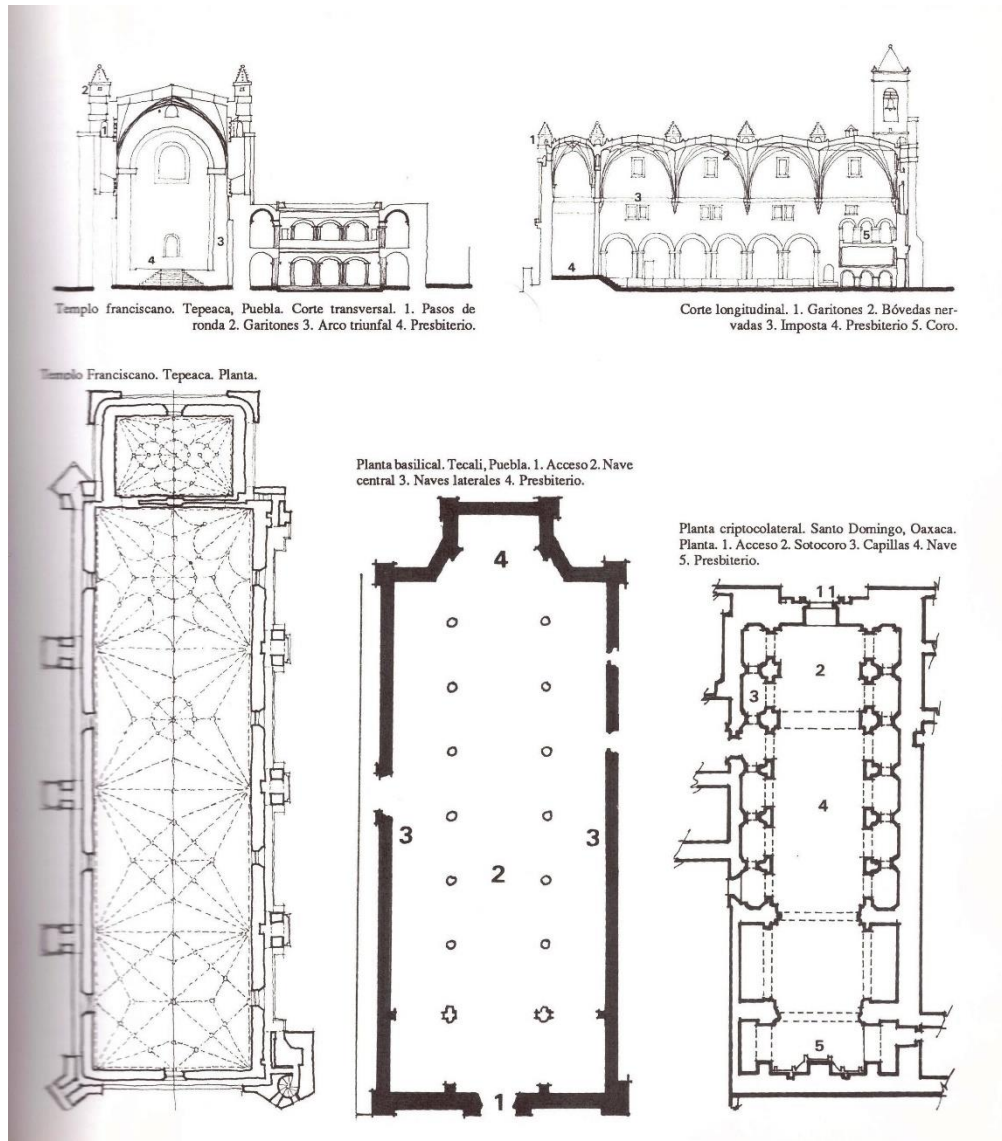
En sentido de las manecillas del reloj: corte transversal, longitudinal y planta arquitectónica corrida del templo de Tepeaca, planta basilical de Tecali, Puebla; y planta criptocolateral de Santo Domingo, Oaxaca. En C. Lira V. (1990, p. 65).
